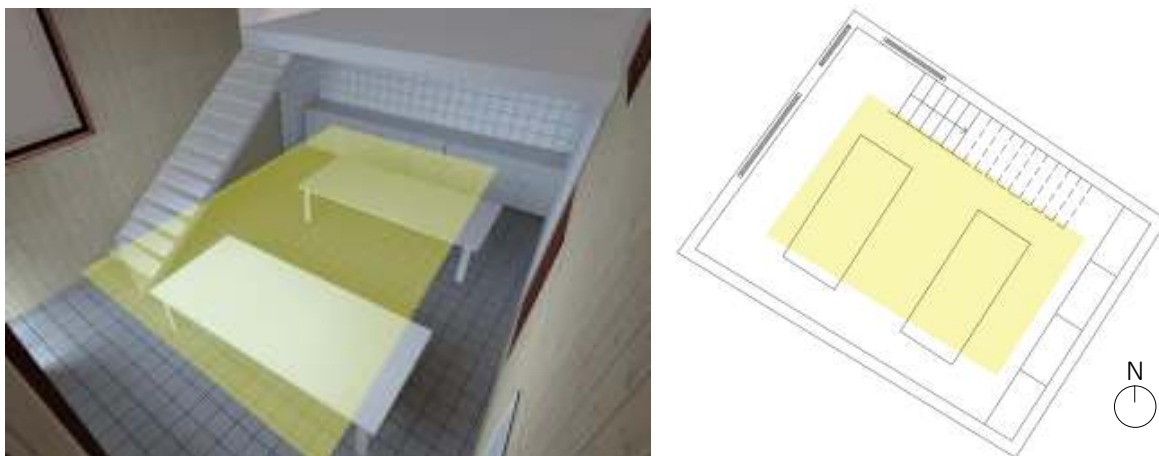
Identificação do plano de trabalho em 3D e planta.
